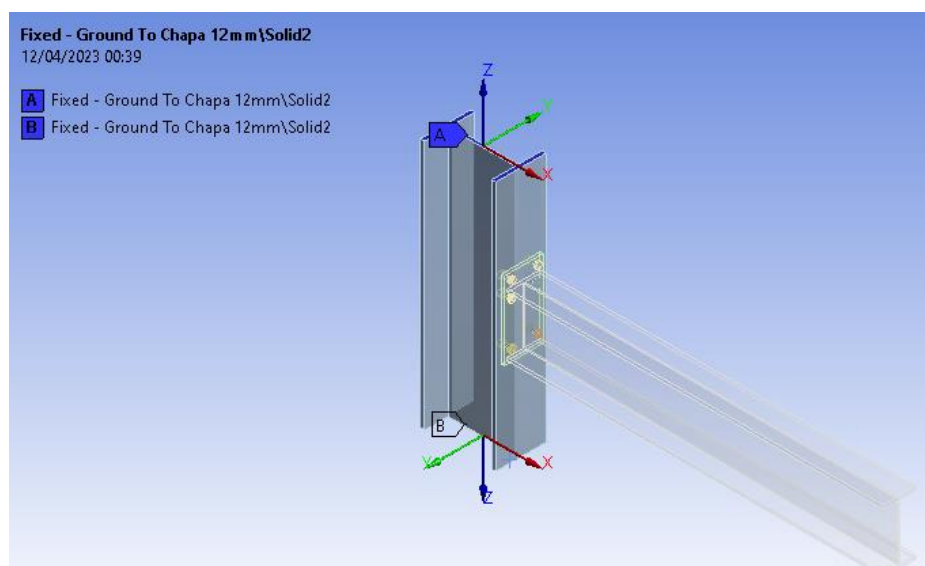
Restrições de movimento aplicadas na coluna – Do próprio autor
